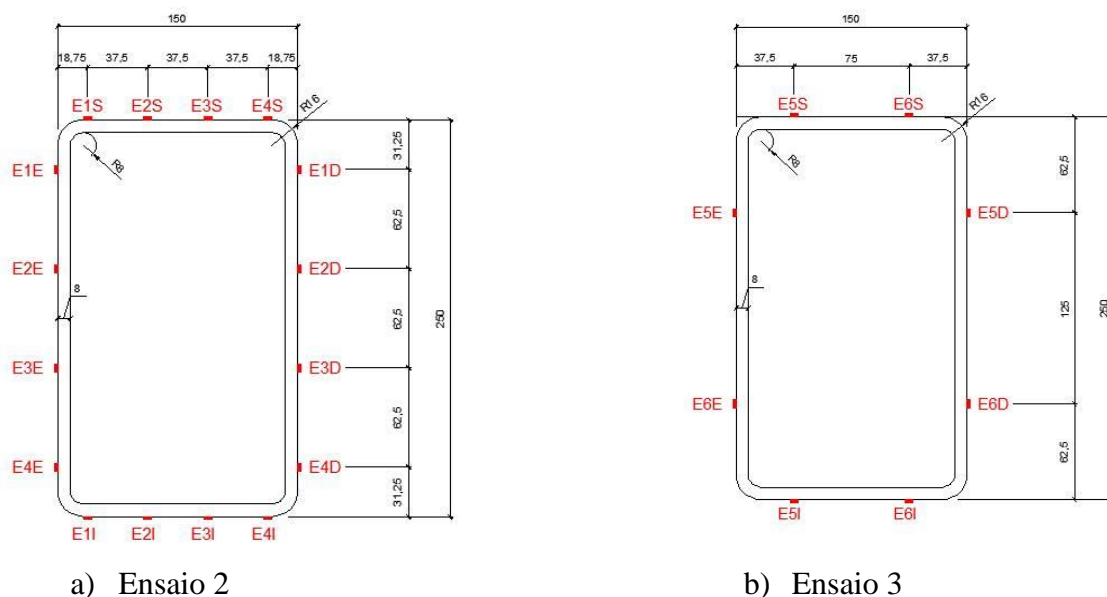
Pormenorização da localização dos extensómetros na ligação “Reverse Channel”
